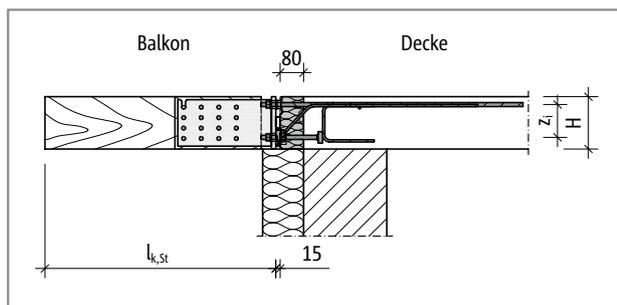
Schöck Isokorb® T Typ SK mit Stahlschwert: Statisches System; Bemessungswerte für den Stahlbeton-Anschluss beziehen sich auf die dargestellte Kraglänge  $l_{k,St}$
